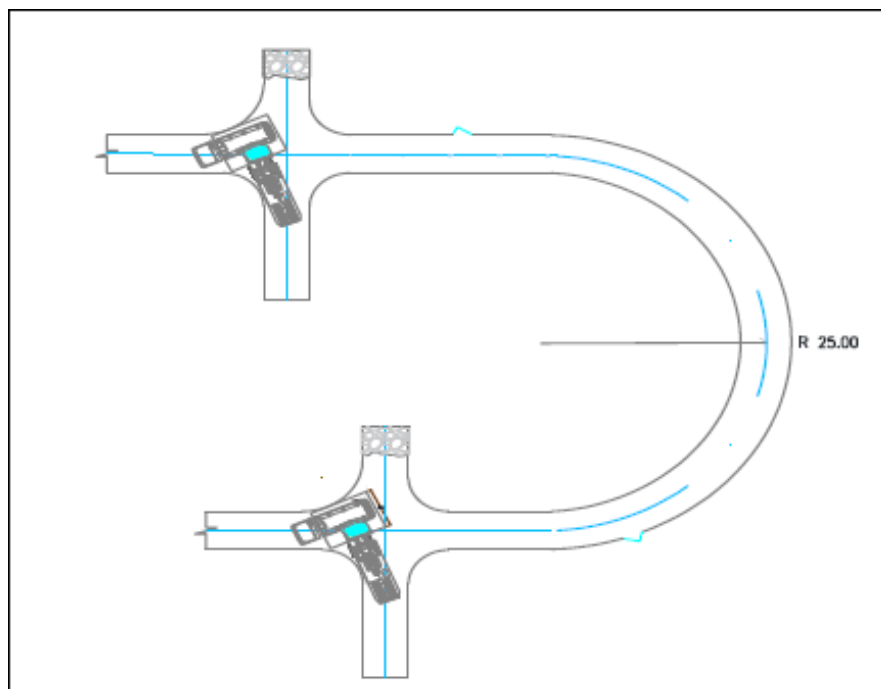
Vista en planta de detalles de la rampa y radios de curvatura
